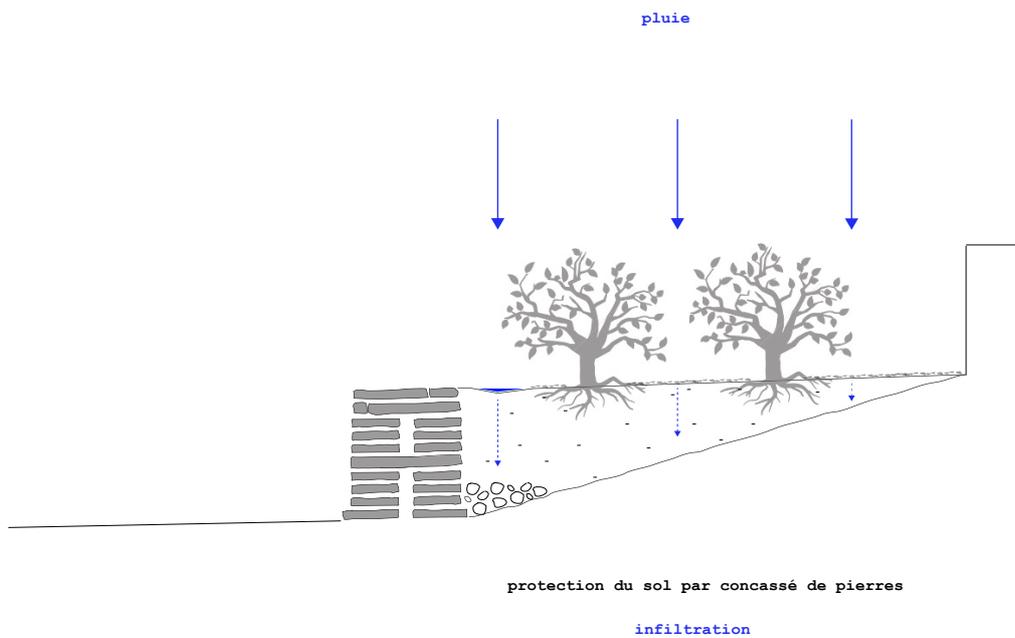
Les murs en pierres sèches favorisent la fertilité des sols
